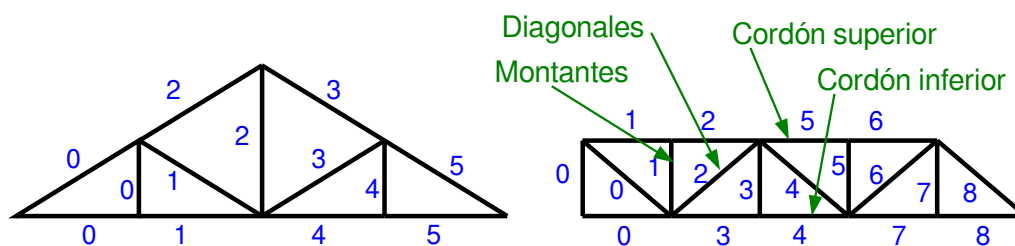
Dos armaduras simples. a) Cercha. b) Viga en celosía
